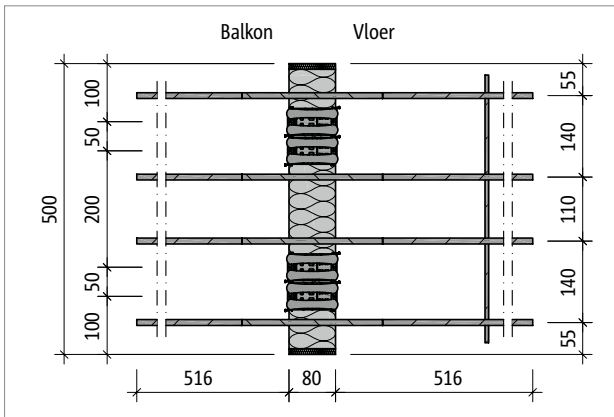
Schöck Isokorf® T type Q-E-V5: Bovenaanzicht
